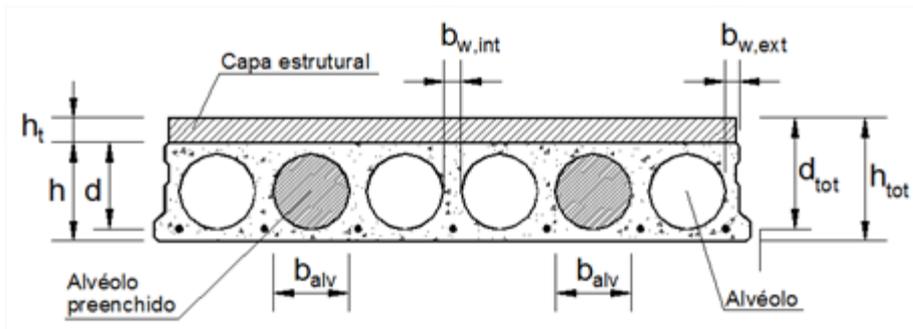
Exemplo de seção transversal de laje alveolar com capa estrutural e alvéolos preenchidos (Fonte: ABNT NBR 14861:2011)
